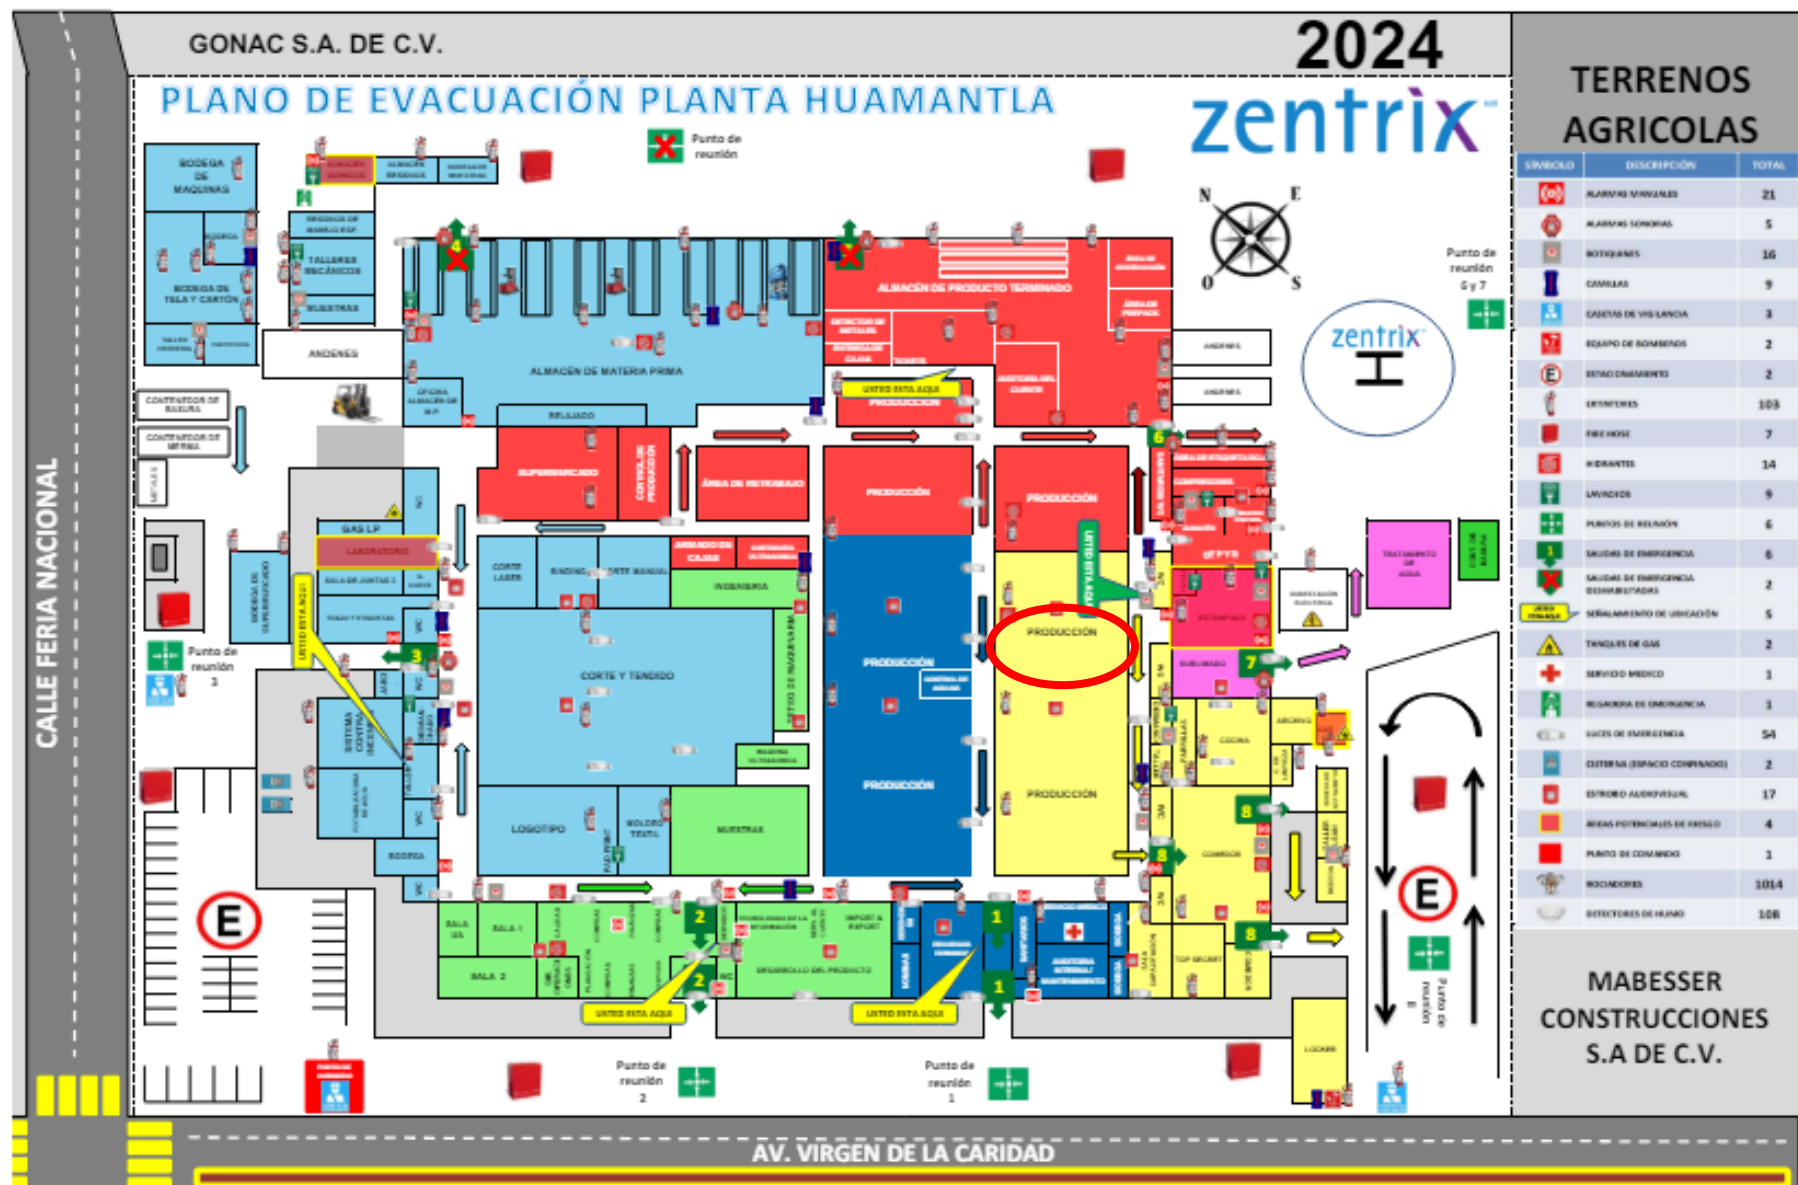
Lay-Out de la empresa y lugar donde se desarrolló el proyecto
